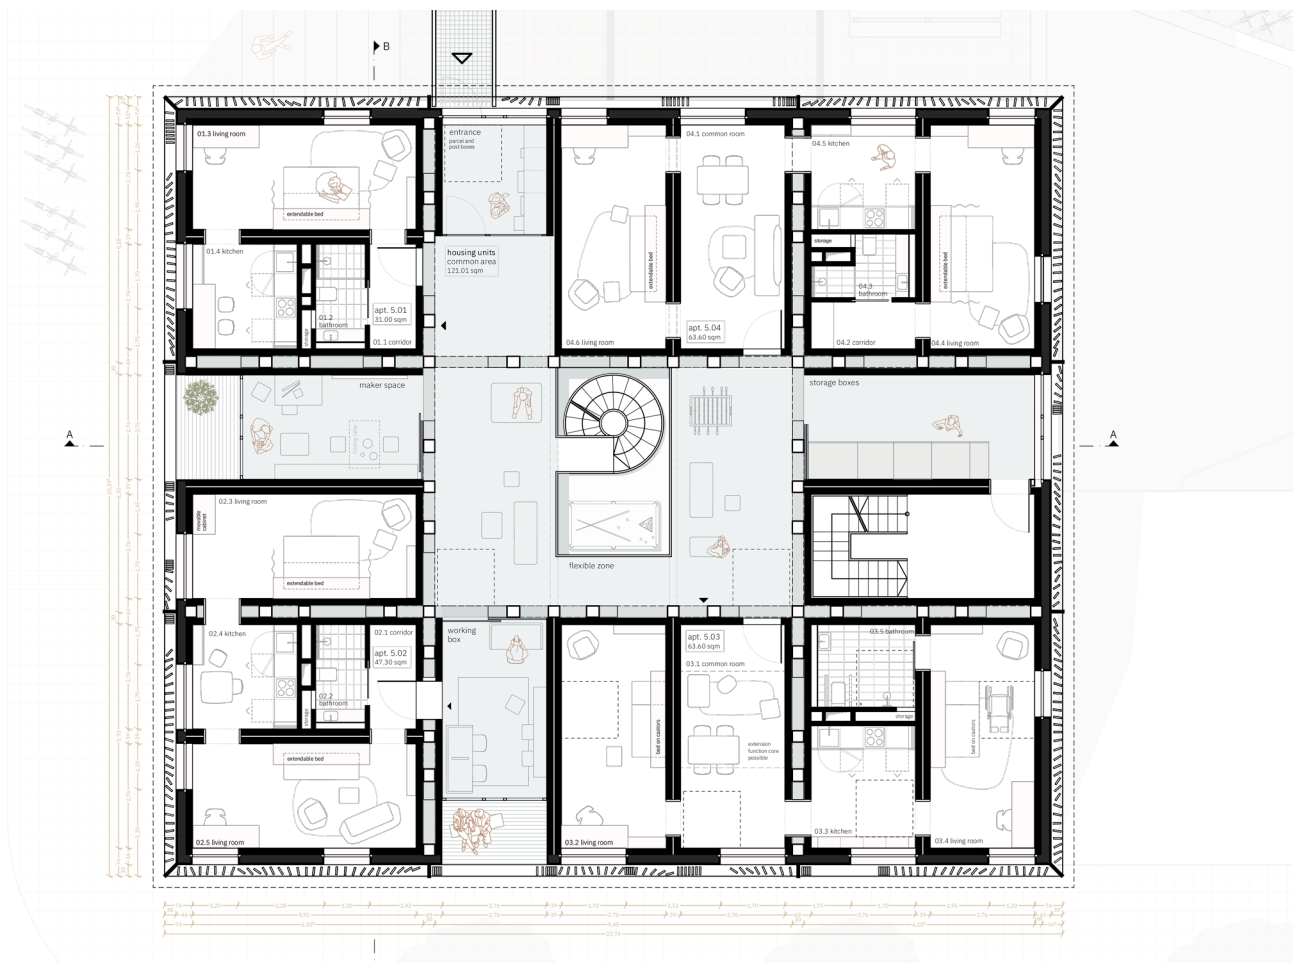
4. Obergeschoss | Wohngeschoss, M 1:200
